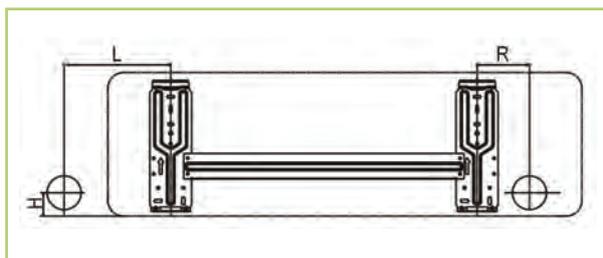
Montagepunkte der Wandhalterung MXW 201/261 und MXW 351 (Frontansicht, alle Maße in mm)
